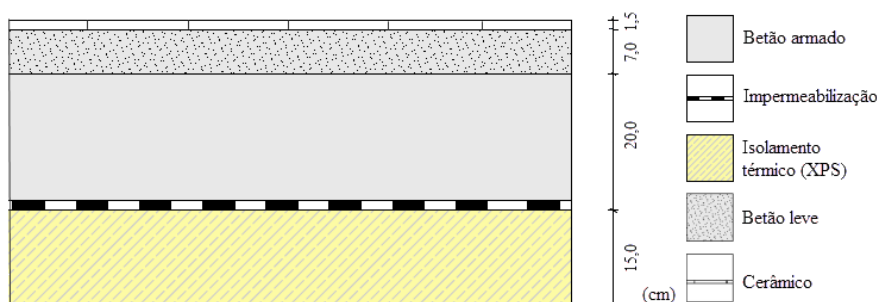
Solução construtiva de pavimento térreo – ensoleiramento
